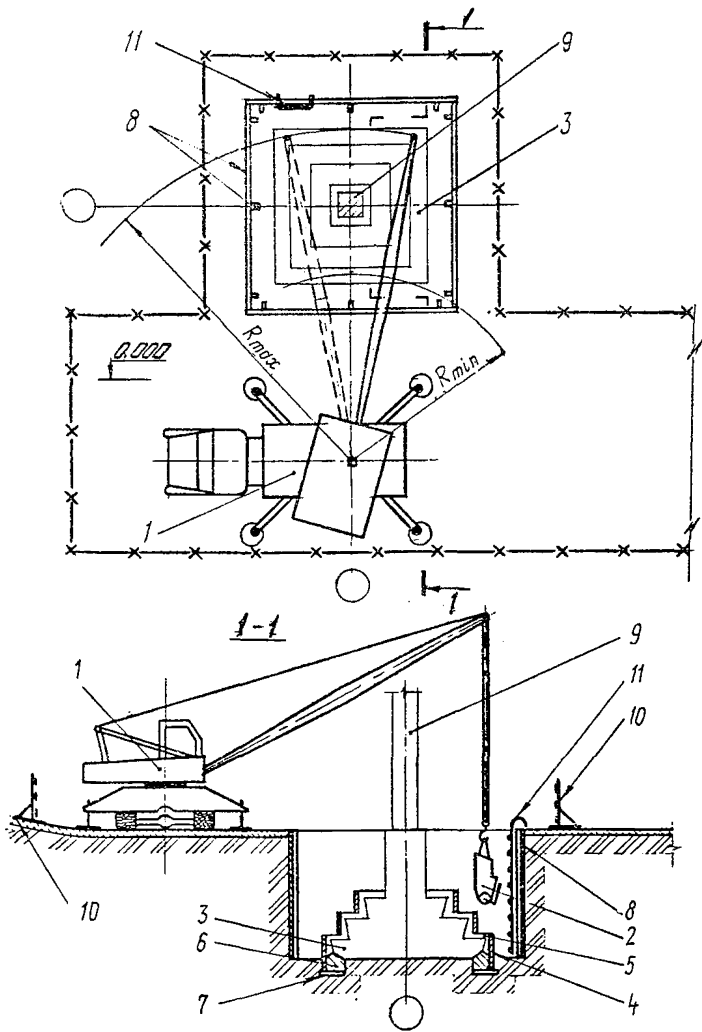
Технологическая схема усиления отдельно стоящих ступенчатых фундаментов:
